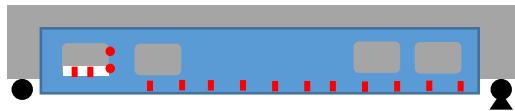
Conexión en laterales de viga, con apertura de ventanas y placas atornilladas.
